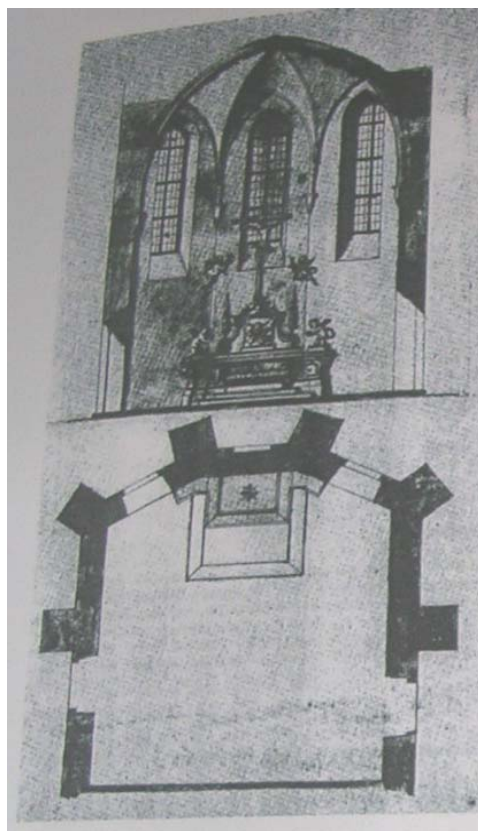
Johann Lukas von Hildebrandt, Grundrissplan und Zeichnung des Chors der Kapelle in Wolfpassing, um 1731.
